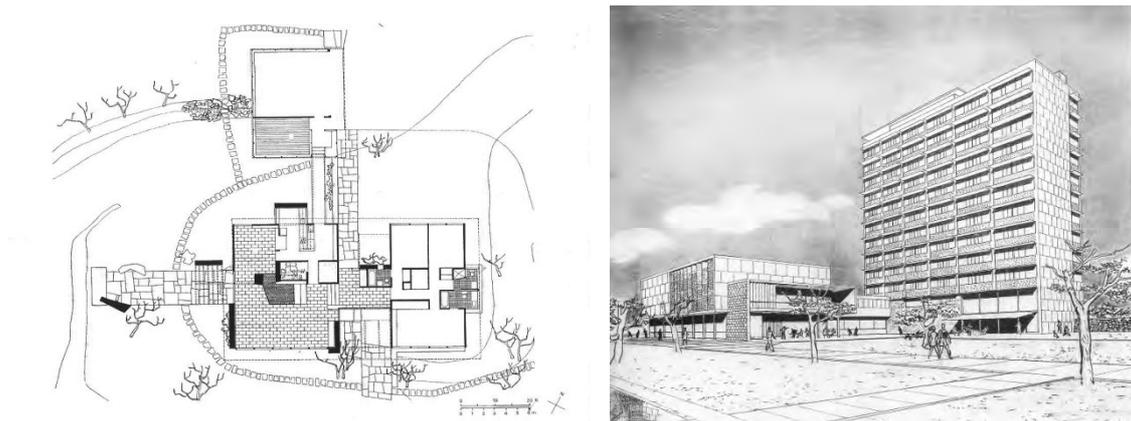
| Planta da Weiss House (1947-50) | Louis Kahn [McCarter]
